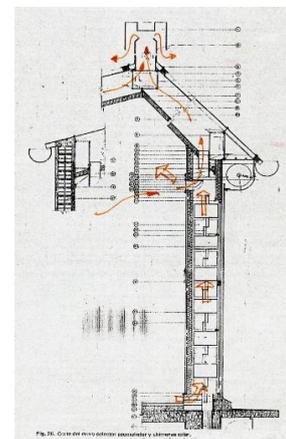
Prototipo Solar. Vista y Detalle corte Muro Colector
